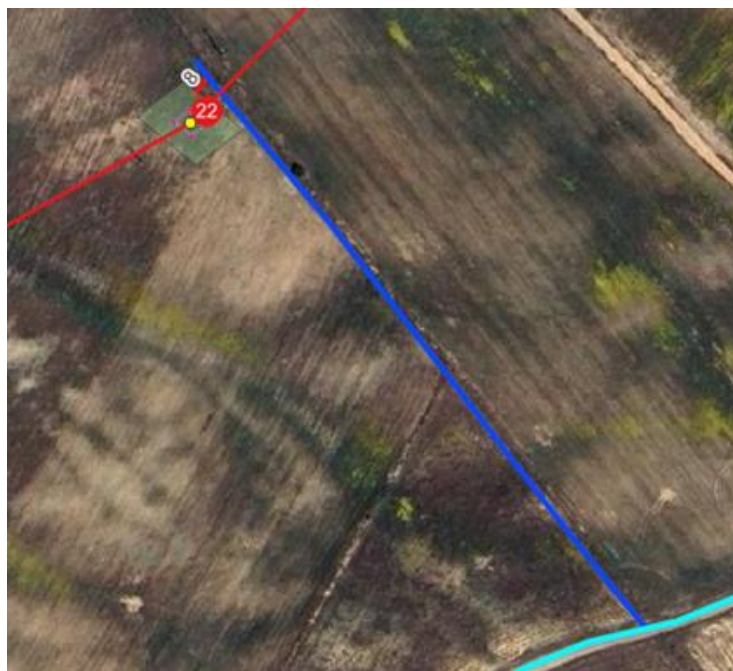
Planta de acesso ao apoio 22(SC2)
